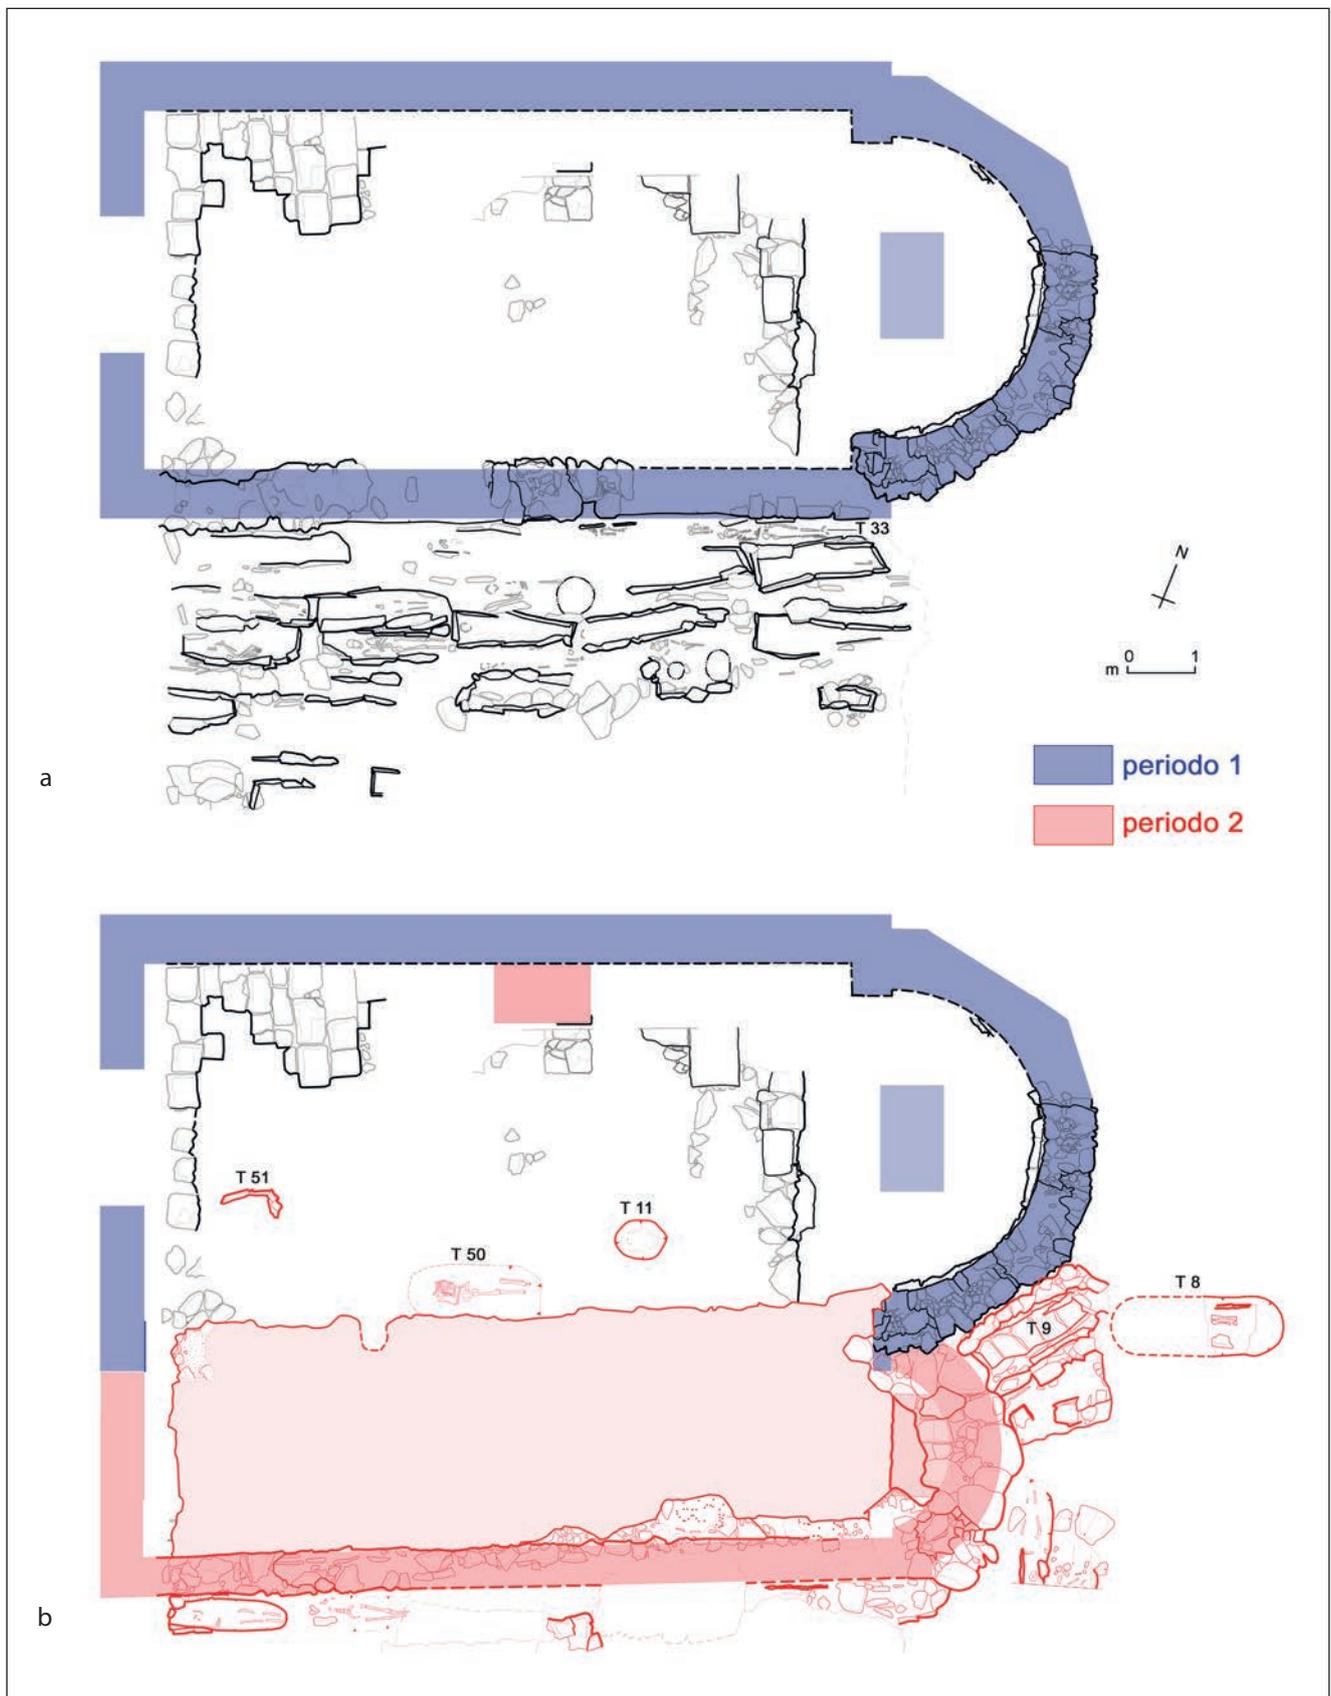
San Maurizio d'Opaglio. Chiesa parrocchiale. Planimetrie ricostruttive dei primi due periodi dell'edificio (ril. M. Zapelloni; elab. L. Pejrani Baricco).
